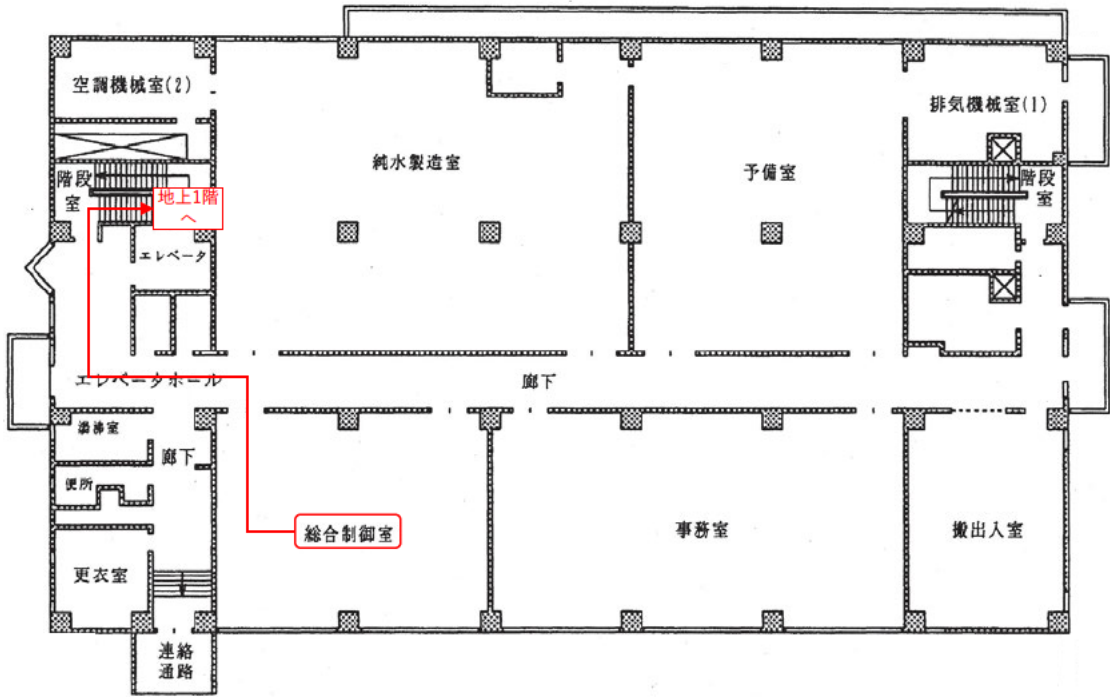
(1) 移動経路 (ユーティリティ施設 3F 平面図)
